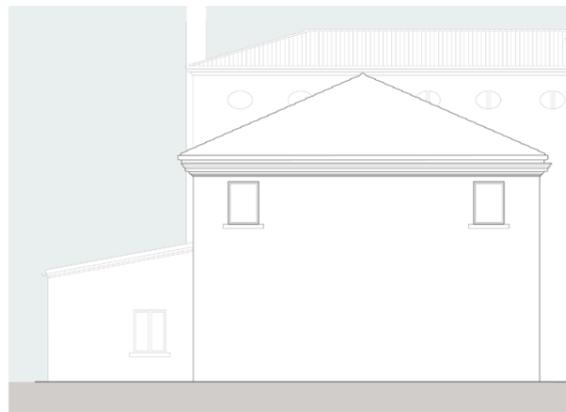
Prospetto nord, rilievo geometrico, scala 1:200
